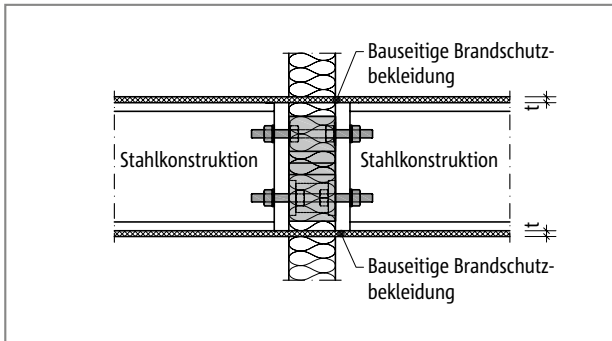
Brandschutz Schöck Isokorb® T Typ S: Bauseitige Brandschutzbekleidung bei bündigen Stirnplatten; Schnitt
